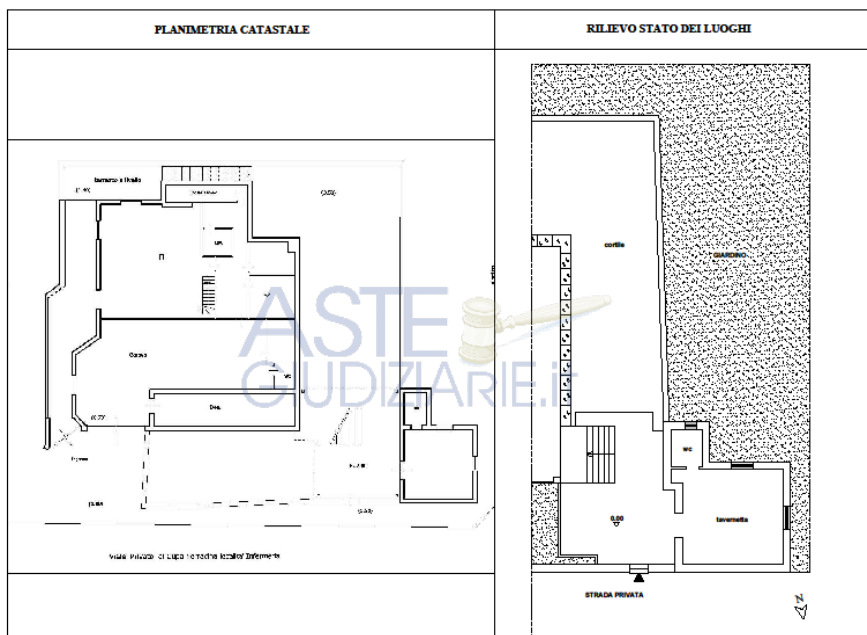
Confronto tra lo stato dei luoghi Primo Piano e la planimetria catastale attuale
